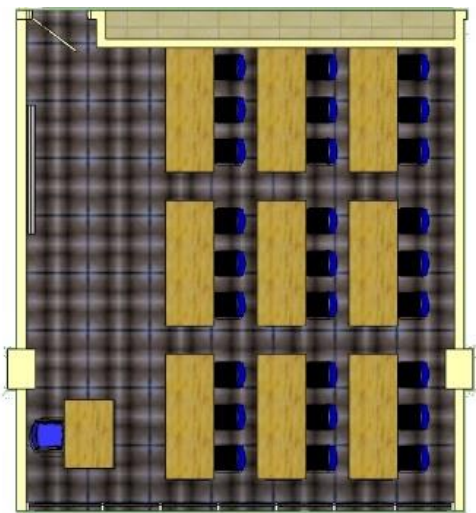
Denah Ruang Kelas 303 dengan Perabot
